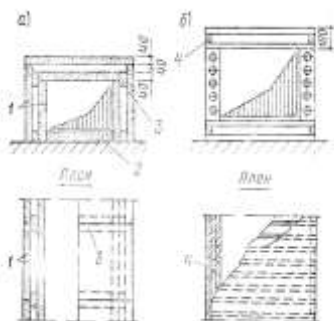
Конструкции сборных коробов: а – из шлакобетонных плит с герметичной воздушной прослойкой, толщиной не более 40 мм; б – со стенками из пеногипсовых или пеностеклянных плит.
